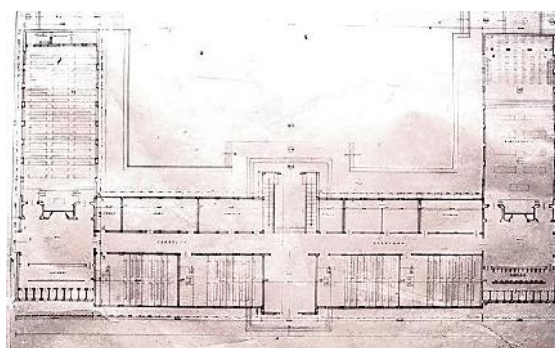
Vistas y plano antiguo edificio de Ingeniería. Foto a color CNM.
